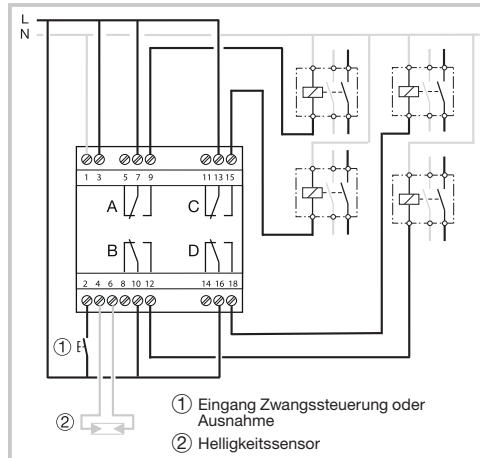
Anschlussplan EGN400 (4 Ausgänge)
